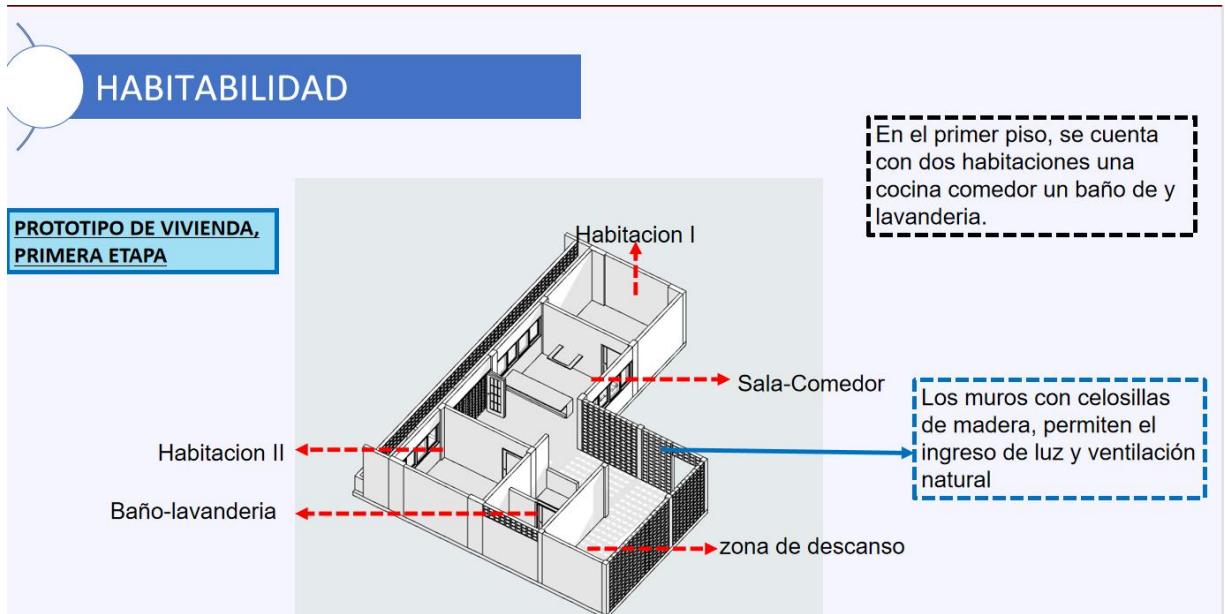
Prototipo de módulo viviendas en su primera etapa.
